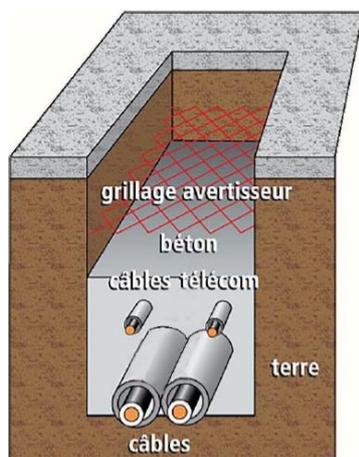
Coupe schématique d'une liaison souterraine en fourreaux PVC
